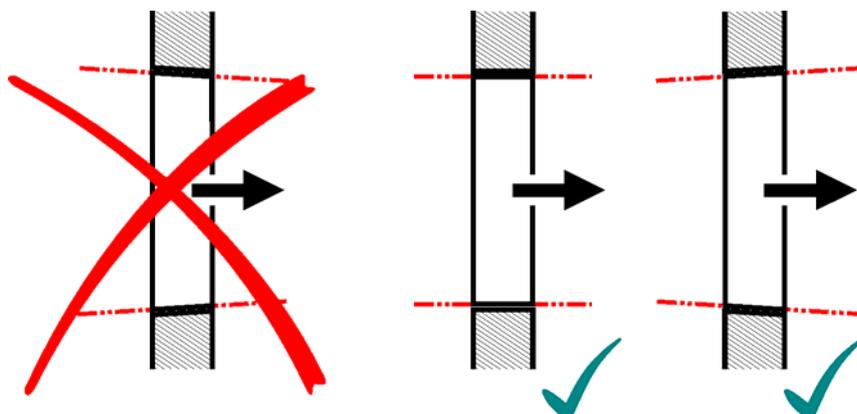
Remoção com cortes perpendiculares e ligeiramente cónicos
